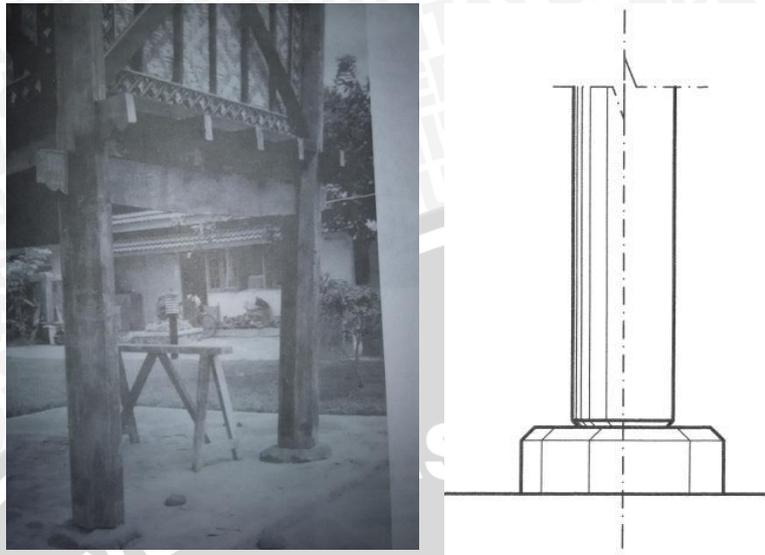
Detail pondasi batu umpak (kiri) dan sketsa (kanan) (Esti, 2011)
